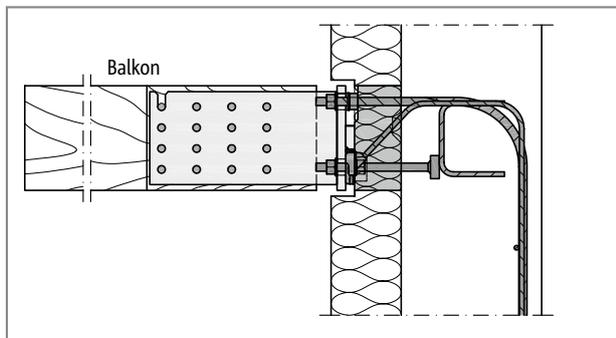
Schöck Isokorb® T Typ SK mit Stahlschwert: Sonderkonstruktion; erforderlich bei Anschluss an eine Stahlbetonwand
